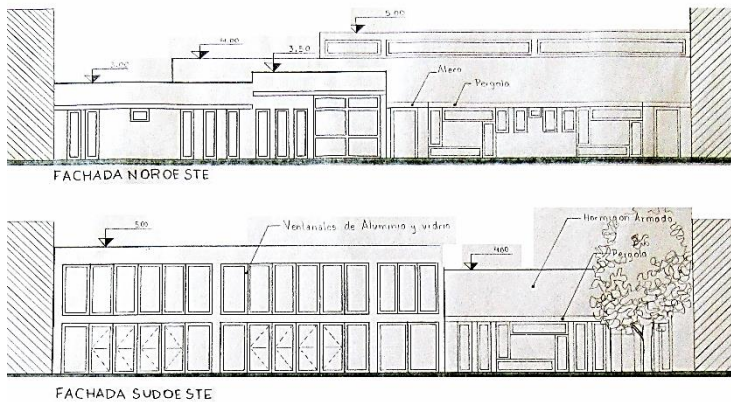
, 26. Expresión arquitectónica. Fachadas.
